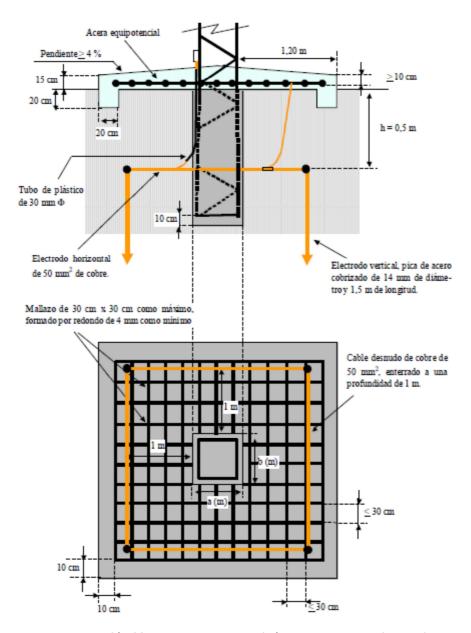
Detalle acero hormigón con mallazo equipotencial
